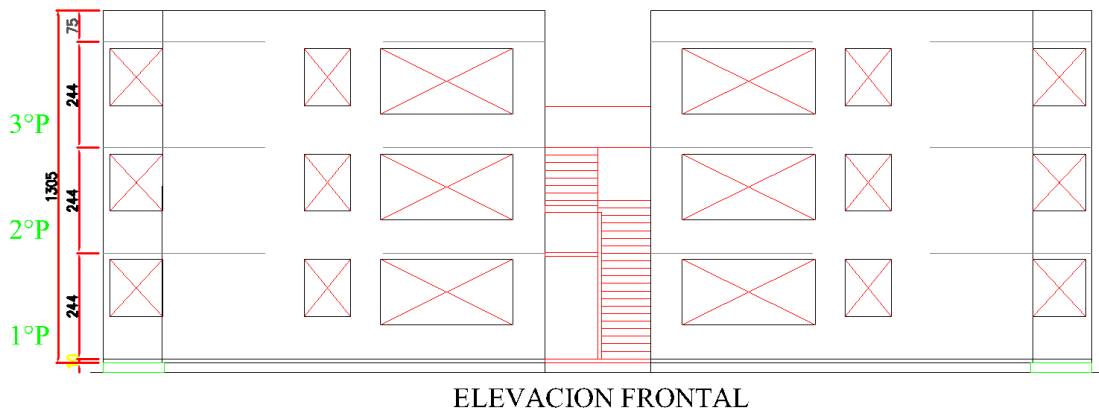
Elevación frontal estructura (medidas en centímetros).
